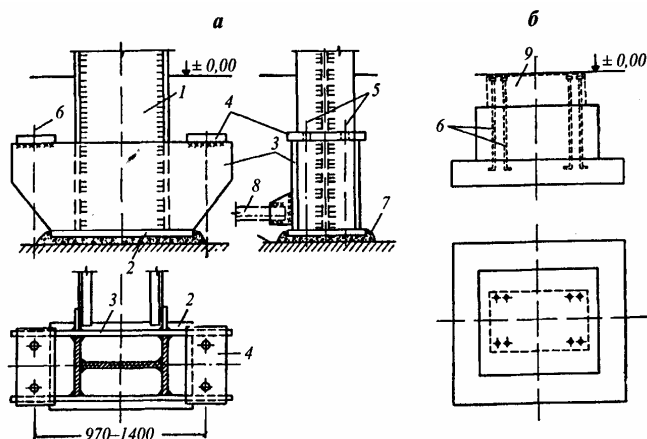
Башмаки и фундаменты стальных колонн:
